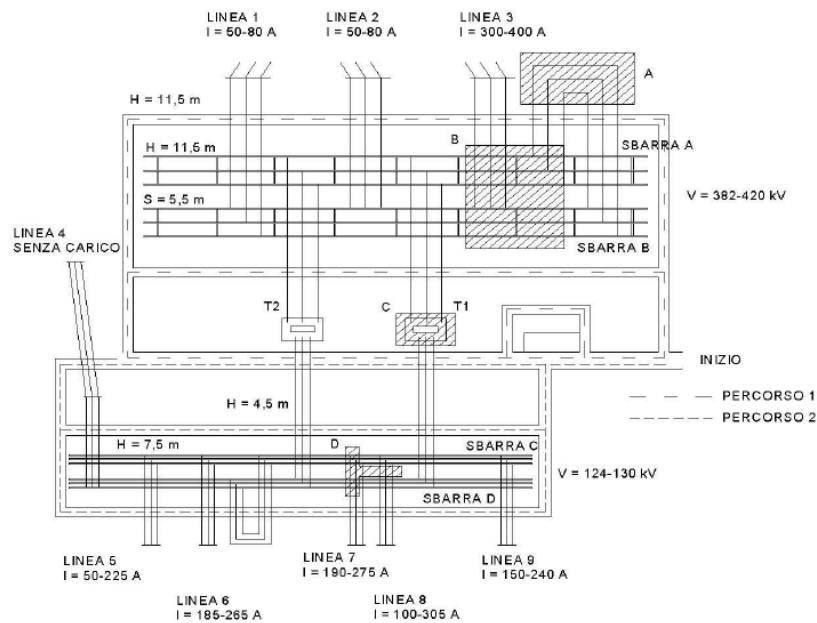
Pianta tipica di una stazione 380/132 kV di Terna con indicazione dei punti di misura
